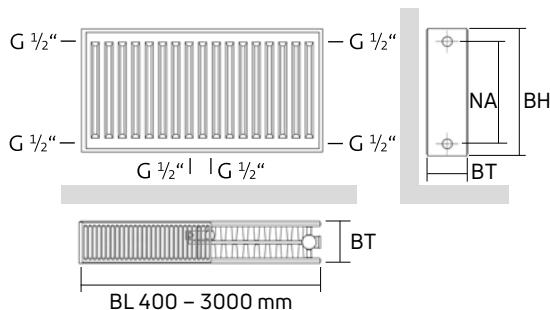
Ventil Compact M 6-Muffen-Profilheizkörper mit Mittenanschluss
